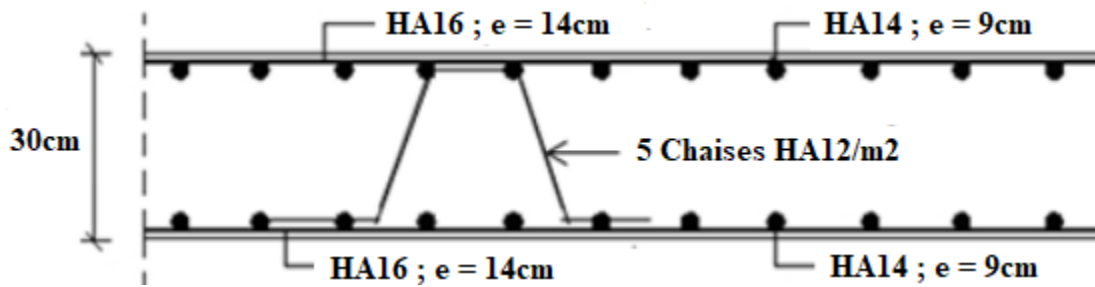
Ferrailage de la Dalle du Radier en travée
